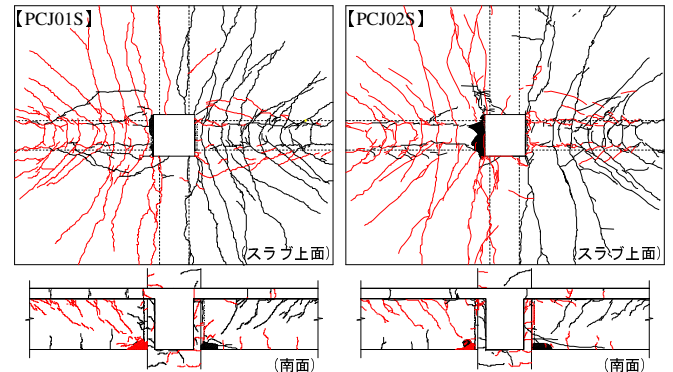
ひび割れ発生状況 (R=4.0%)
